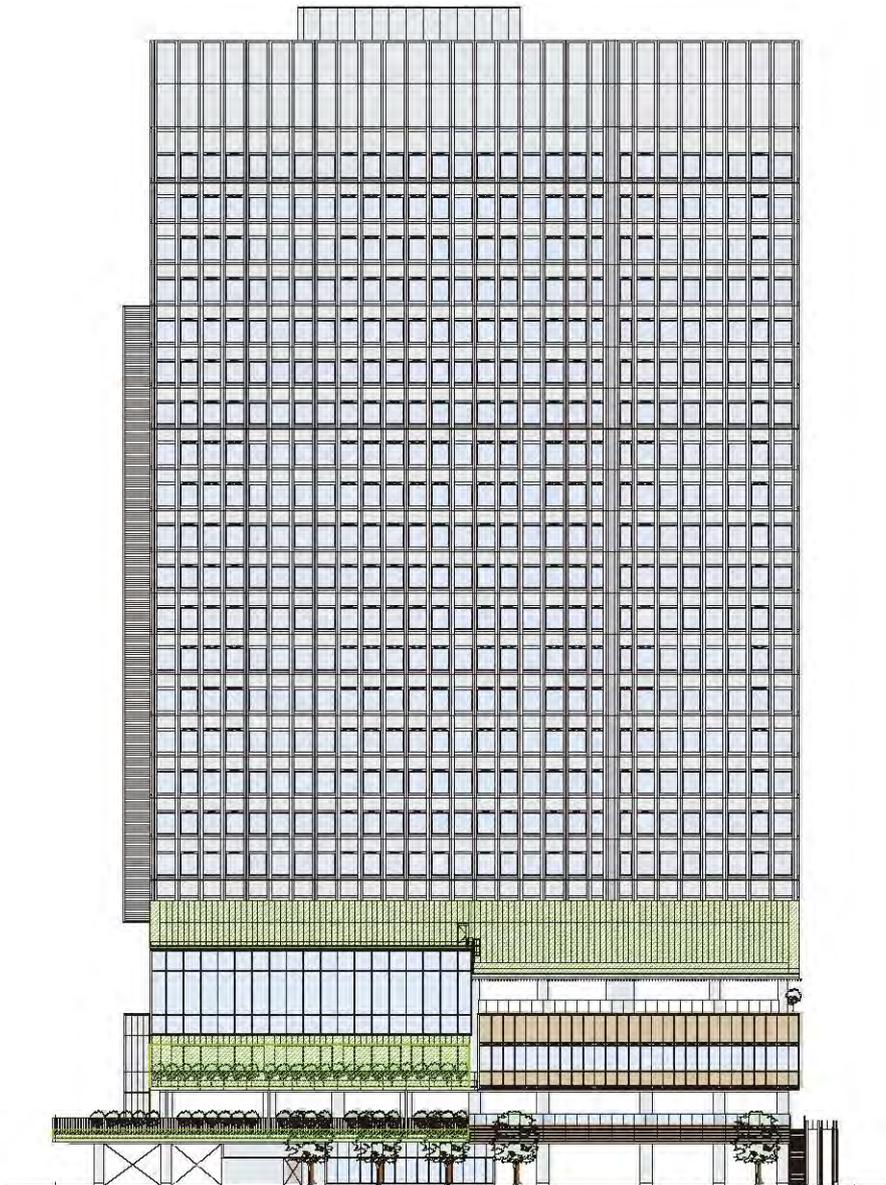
(1) 立面图 (北立面图 S=1:800) 【变更后】
